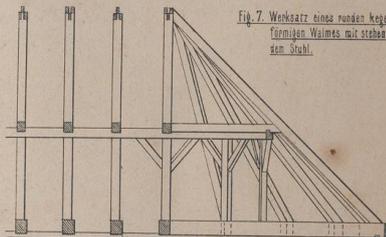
Werkssatz eines runden kegelförmigen Walms mit stehendem Stuhl.
